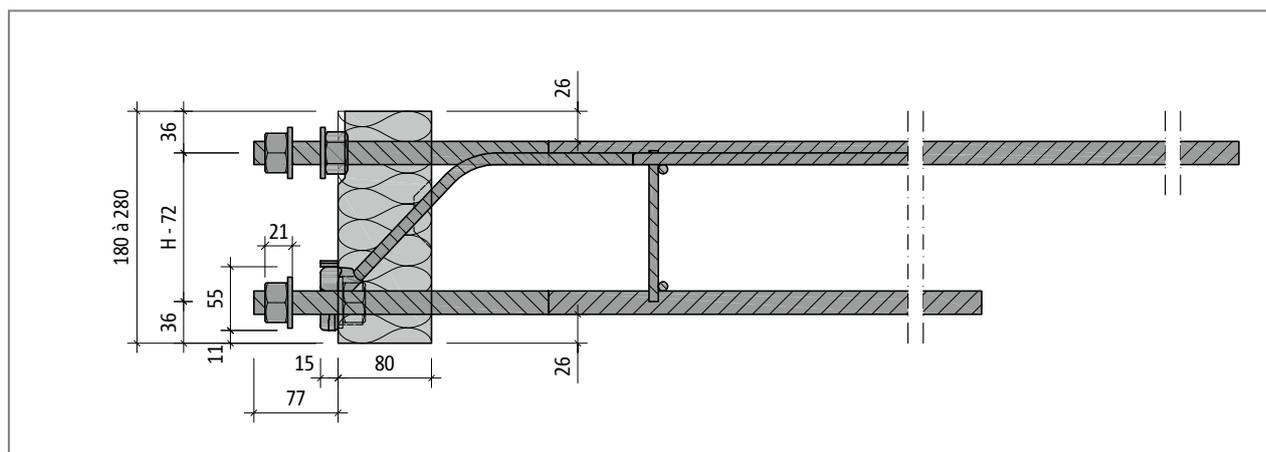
Schöck Isokorb® T type SK-MM2-VV1 : coupe du produit
